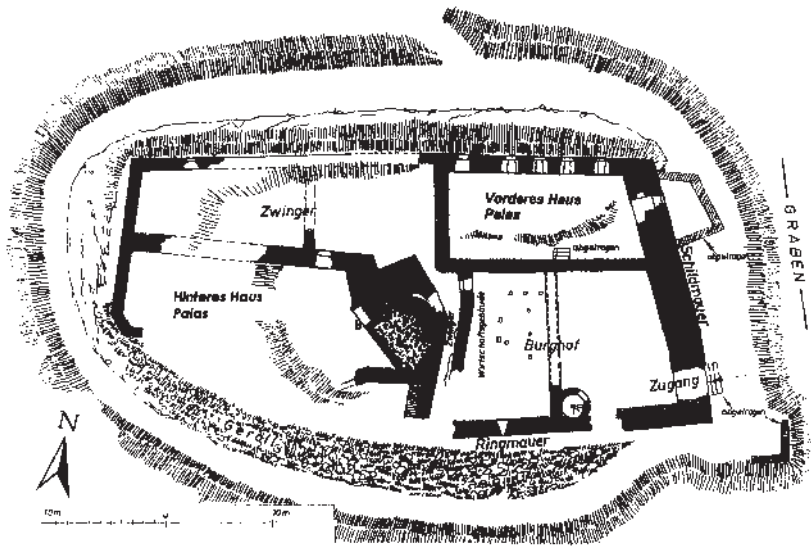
Wilenstein: Wilenstein. Grundriss (1962).
